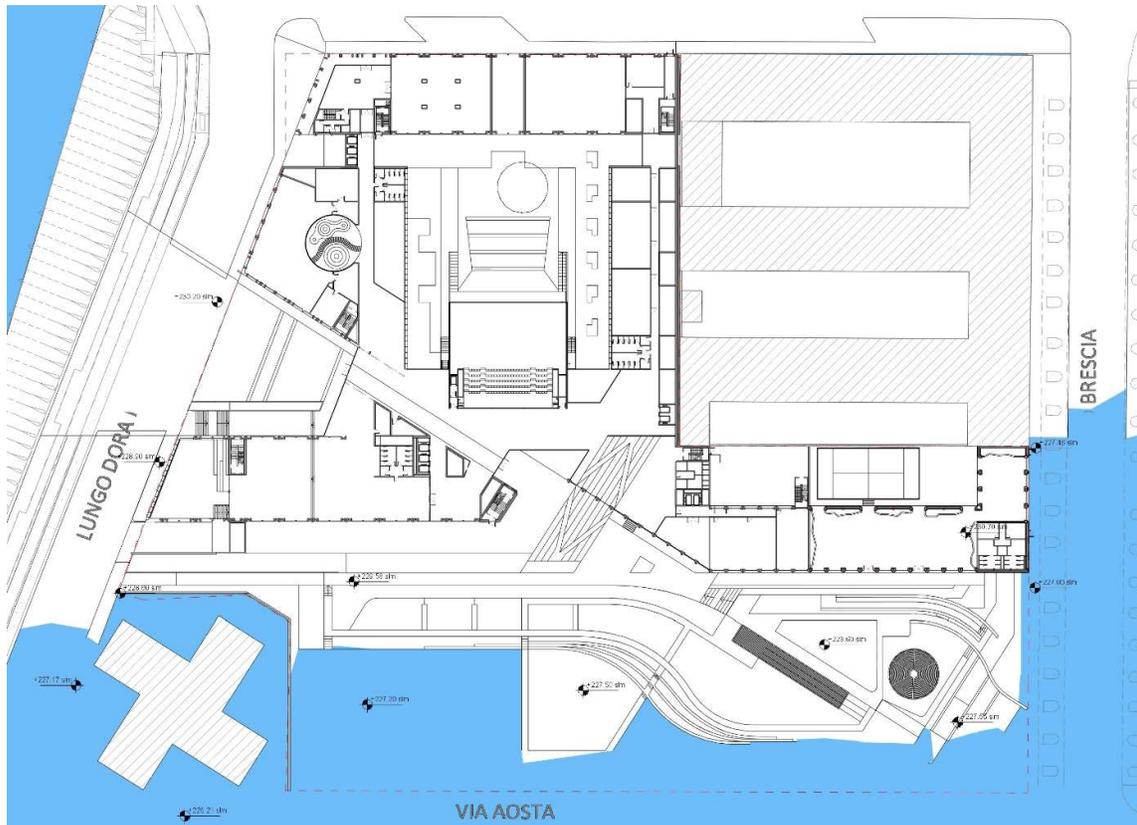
planimetria di progetto e in blu aree aventi elevazione inferiore a 227,50 m s.l.m.
